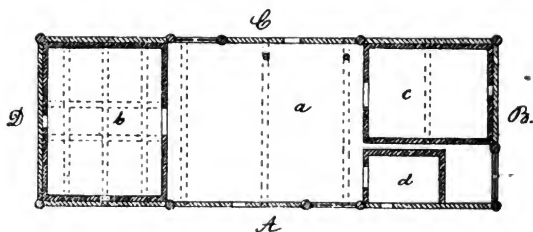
Grundriss desselben Viehstalles.
